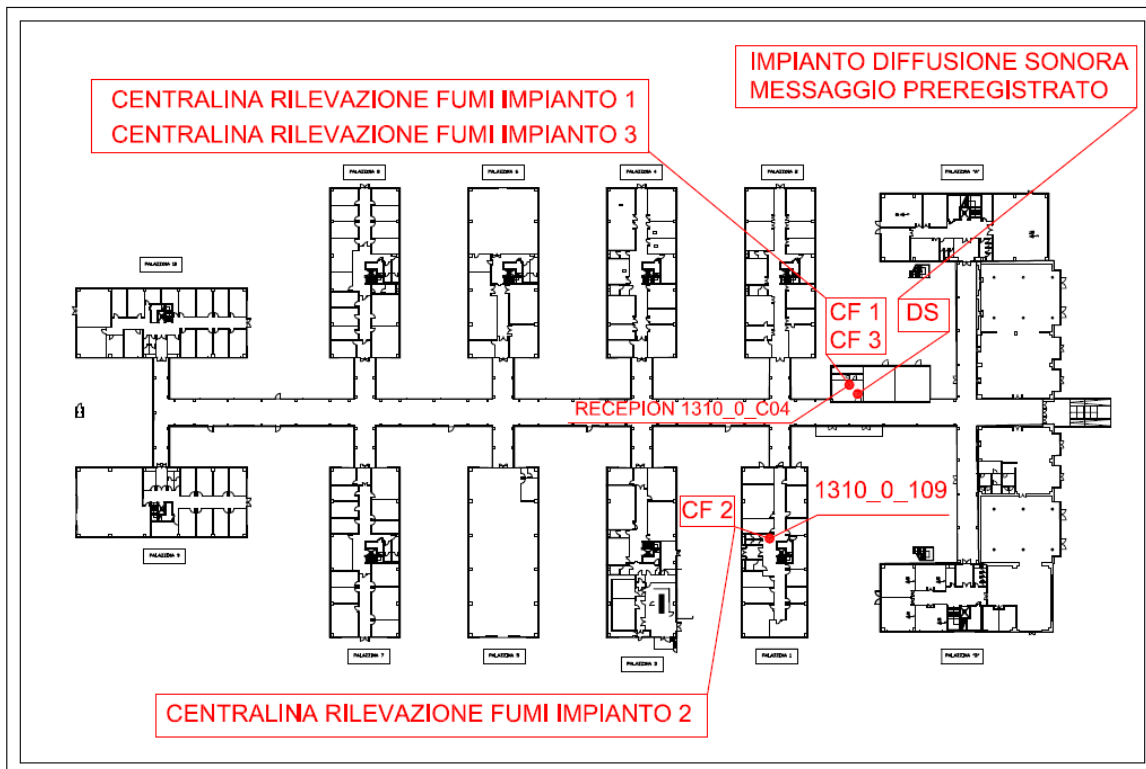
Ubicazione centraline impianti rilevazione fumi – Stralcio delle planimetrie di emergenza.
